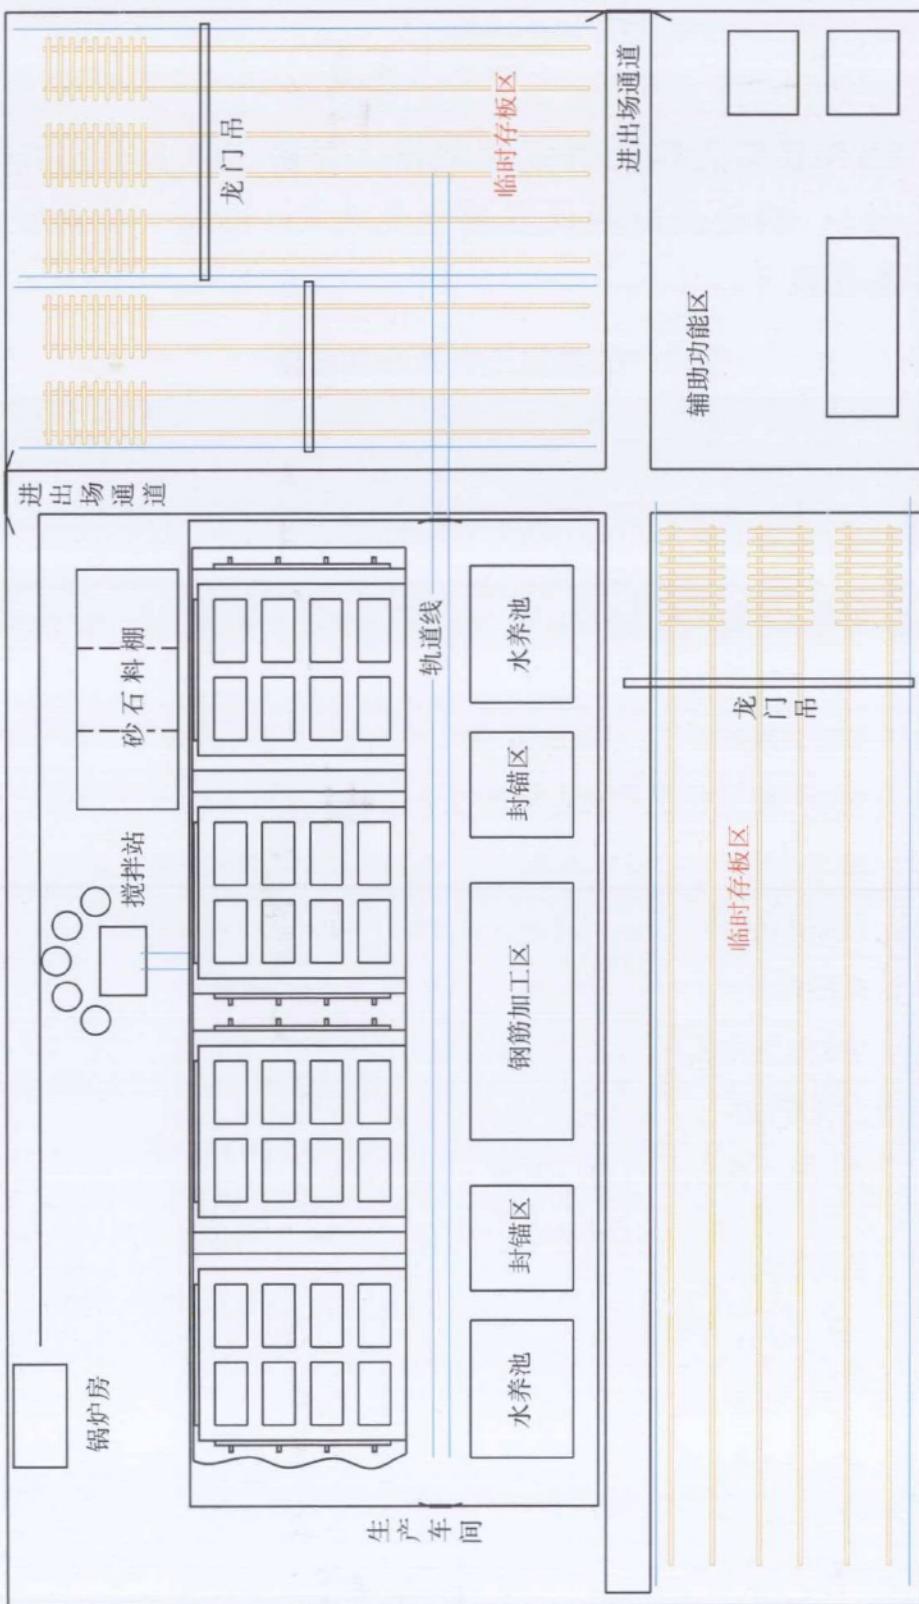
CRTS III 型先张法预应力混凝土预制板平面布置示意
